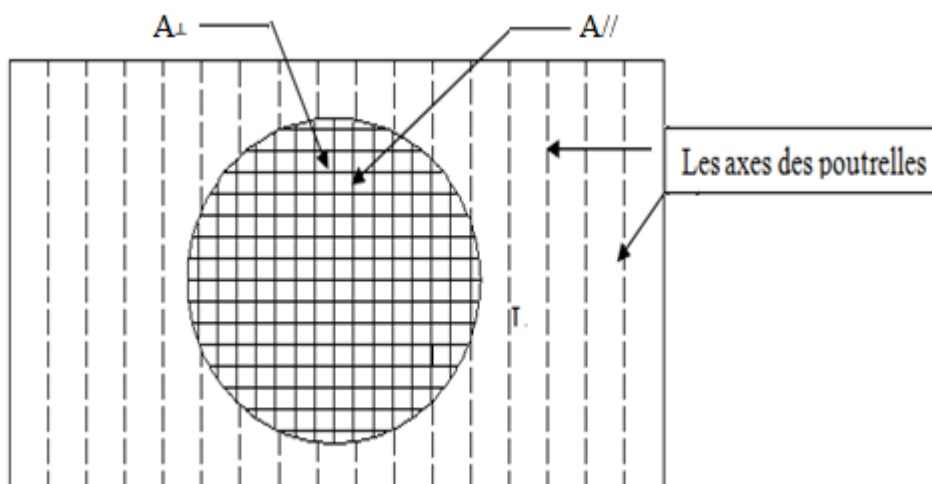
Schéma de Ferrailage de la dalle de compression.
